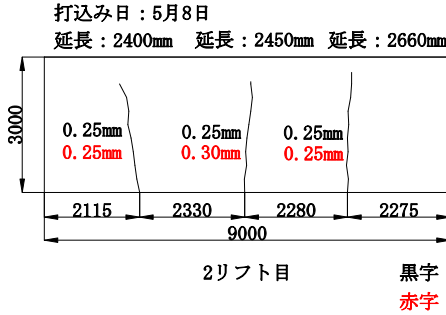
Case Nにおけるひび割れの発生状況（正面図）
